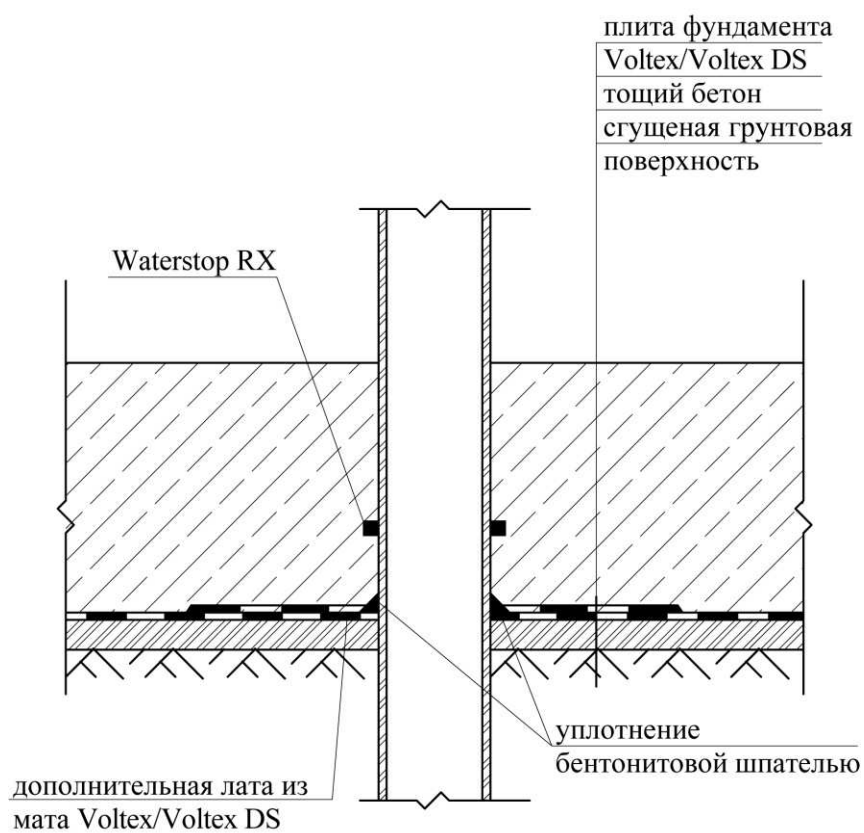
Уплотнение бентонитовой гидроизоляции в месте прохождения через плиту фундамента
